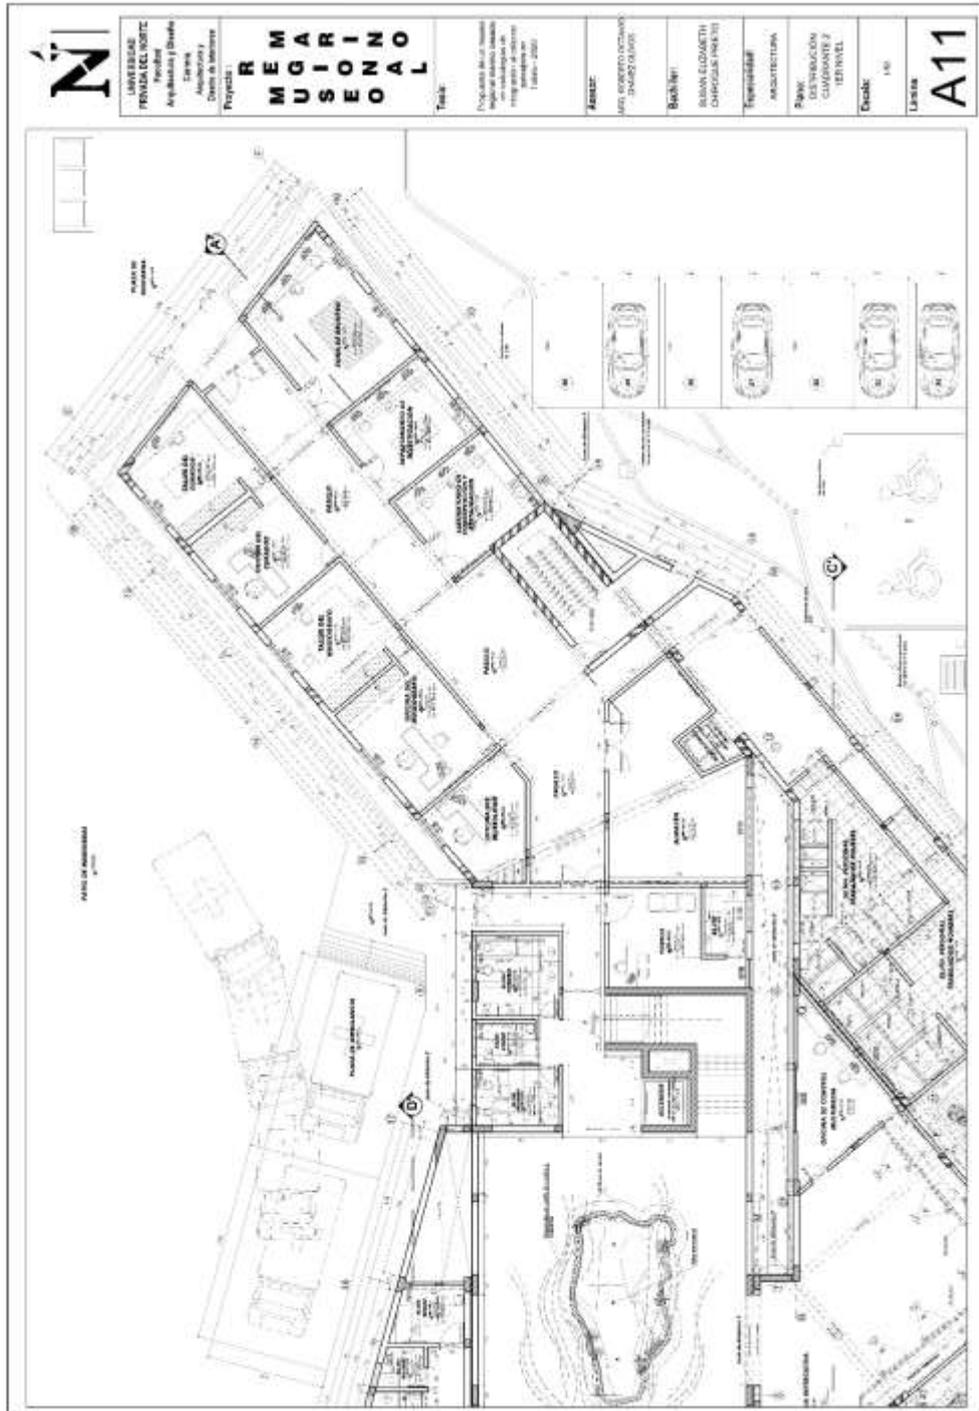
Distribución a detalle sector primer nivel segundo cuadrante.
